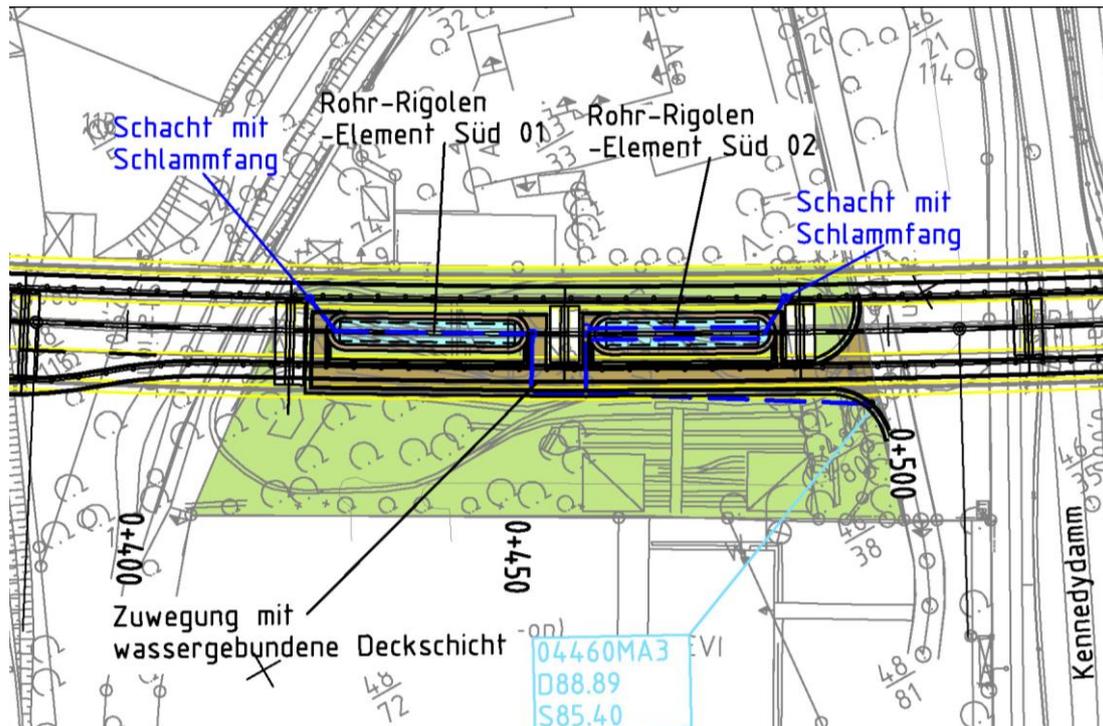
Lage Rohr-Rigolen-Systeme Entwässerungsabschnitt 2
